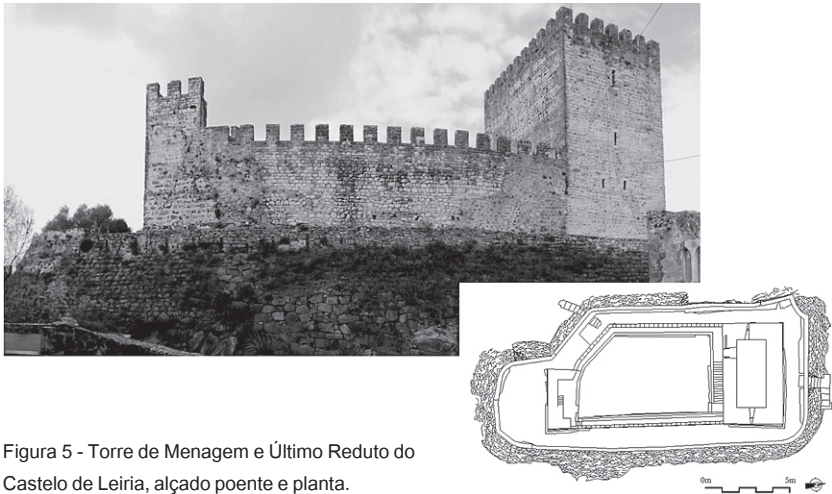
Torre de Menagem e Último Reduto do Castelo de Leiria, alçado poente e planta.
